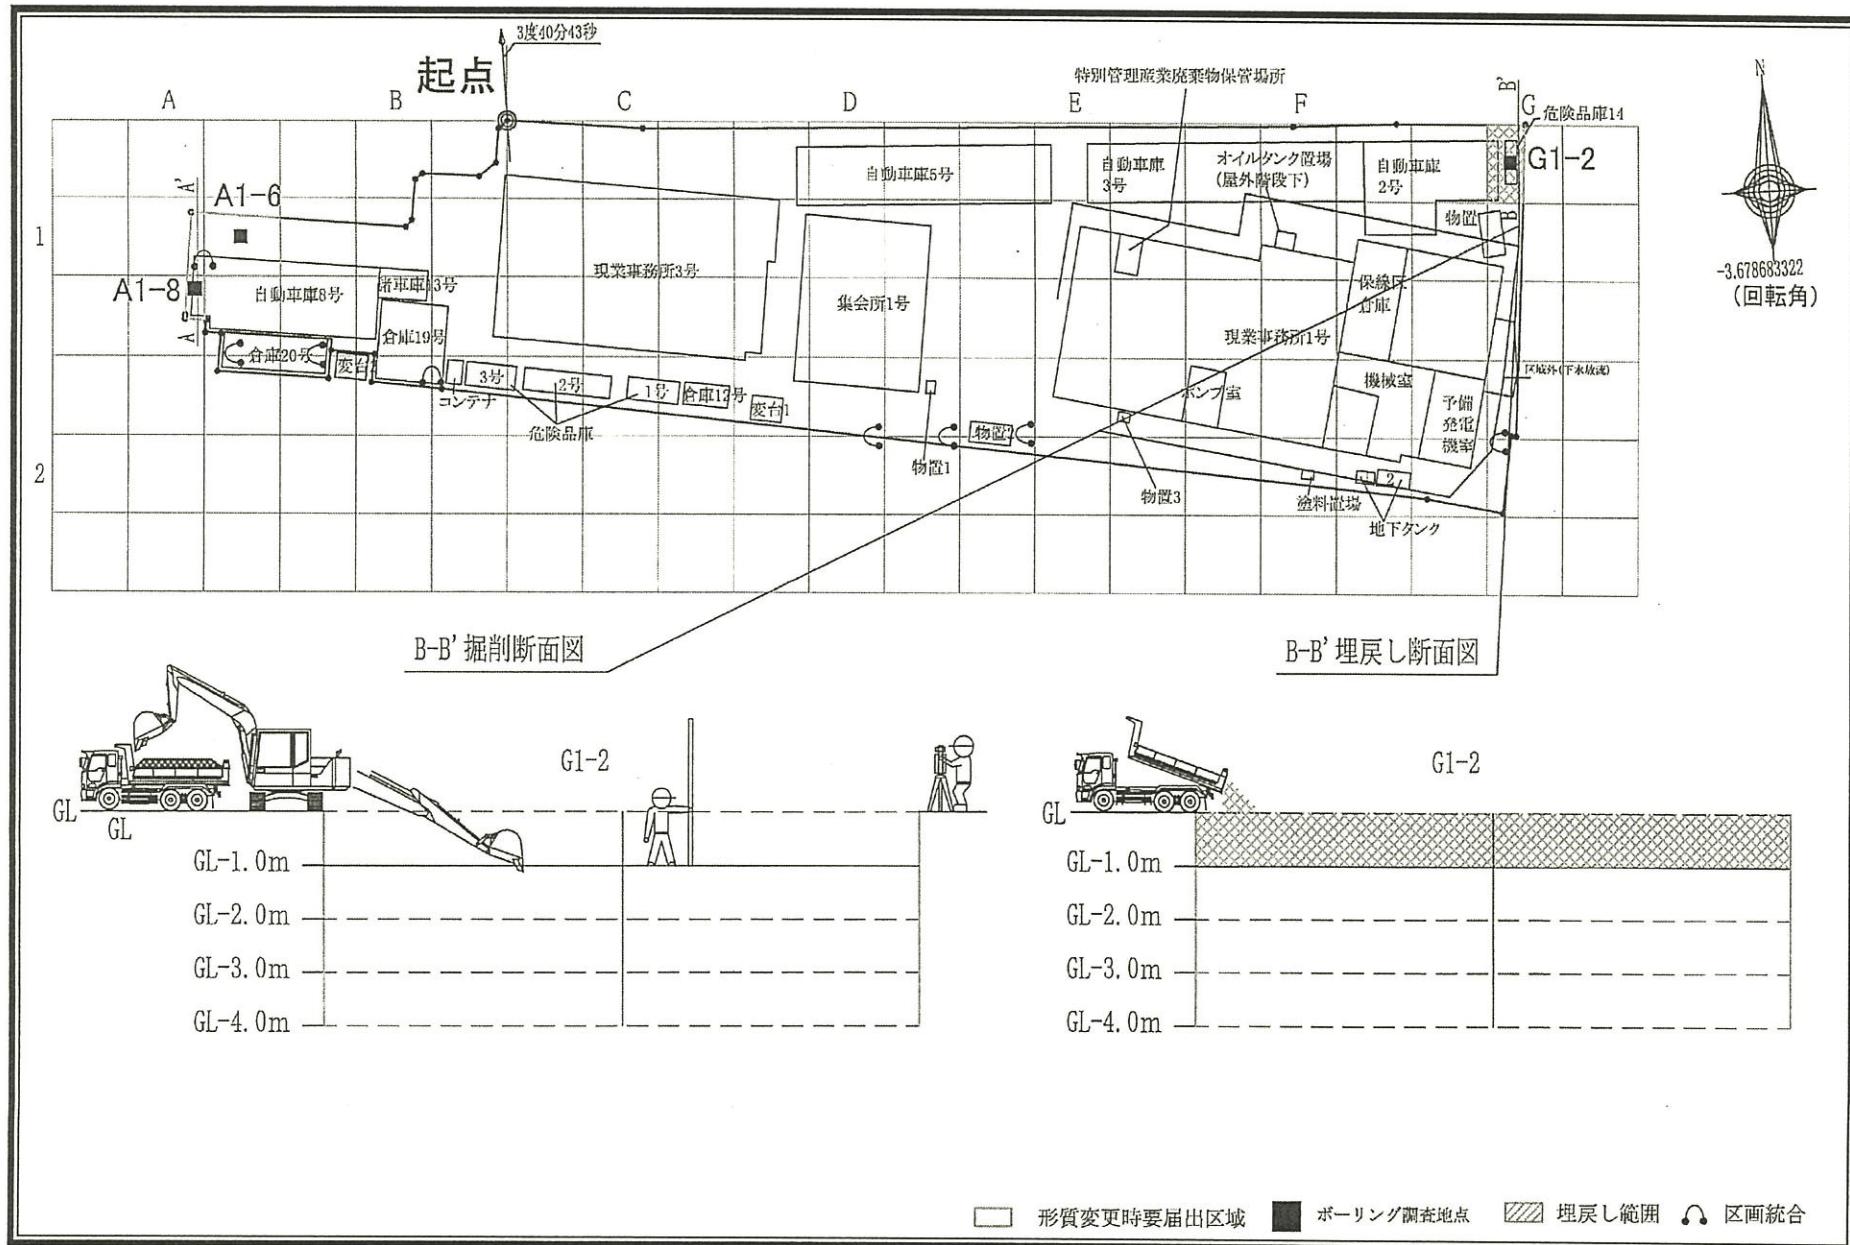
措置対策施工平面・断面図 (G1-2 区画)
